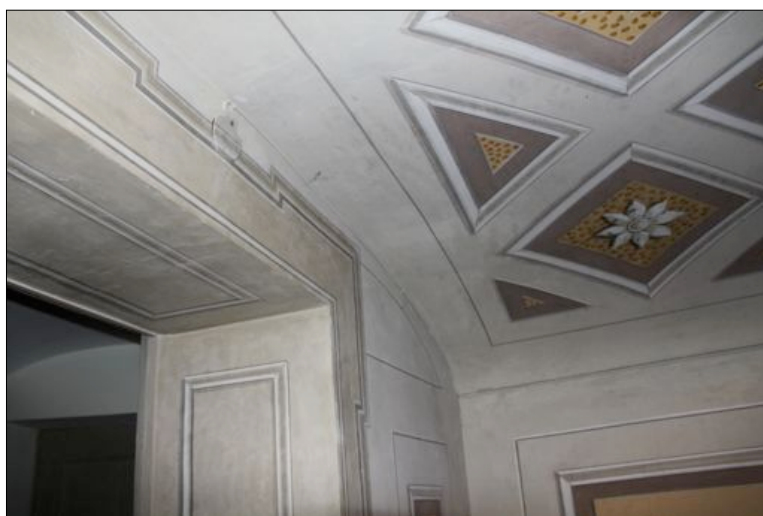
Elementi dell'impianto elettrico 'mimetizzato' con la decorazione delle pareti dei palchi. (foto 2011)
